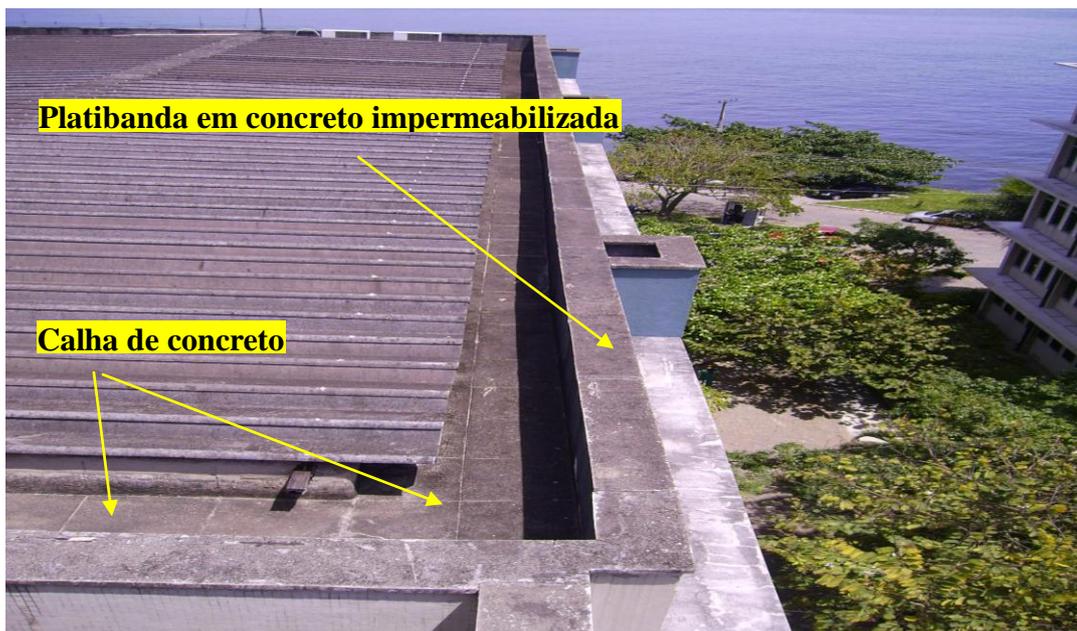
Vista parcial de cima da cobertura do prédio do bloco "O". Telhas de fibrocimento, calhas de concreto com impermeabilização e captadores das águas de chuva na cor azul
